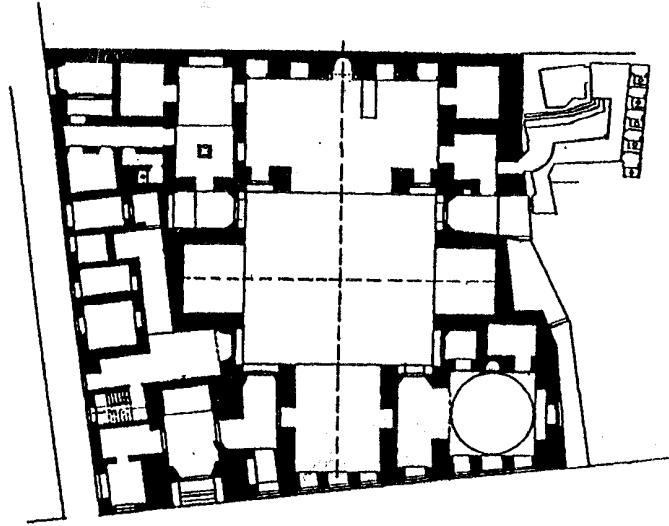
مسقط أفقي لمدرسة صرغتمش بالقاهرة (عن Kessler)
